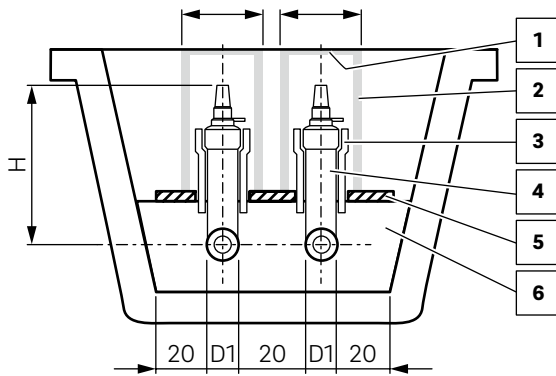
Esquema de montaje de la llave de corte enterrada
